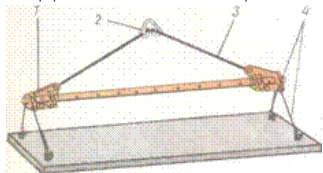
Балочная траверса с передвигаемыми обоймами 1 — передвигаемая обойма; 2 — серьга; 3 — подвеска; 4 — стропобочный канаты
